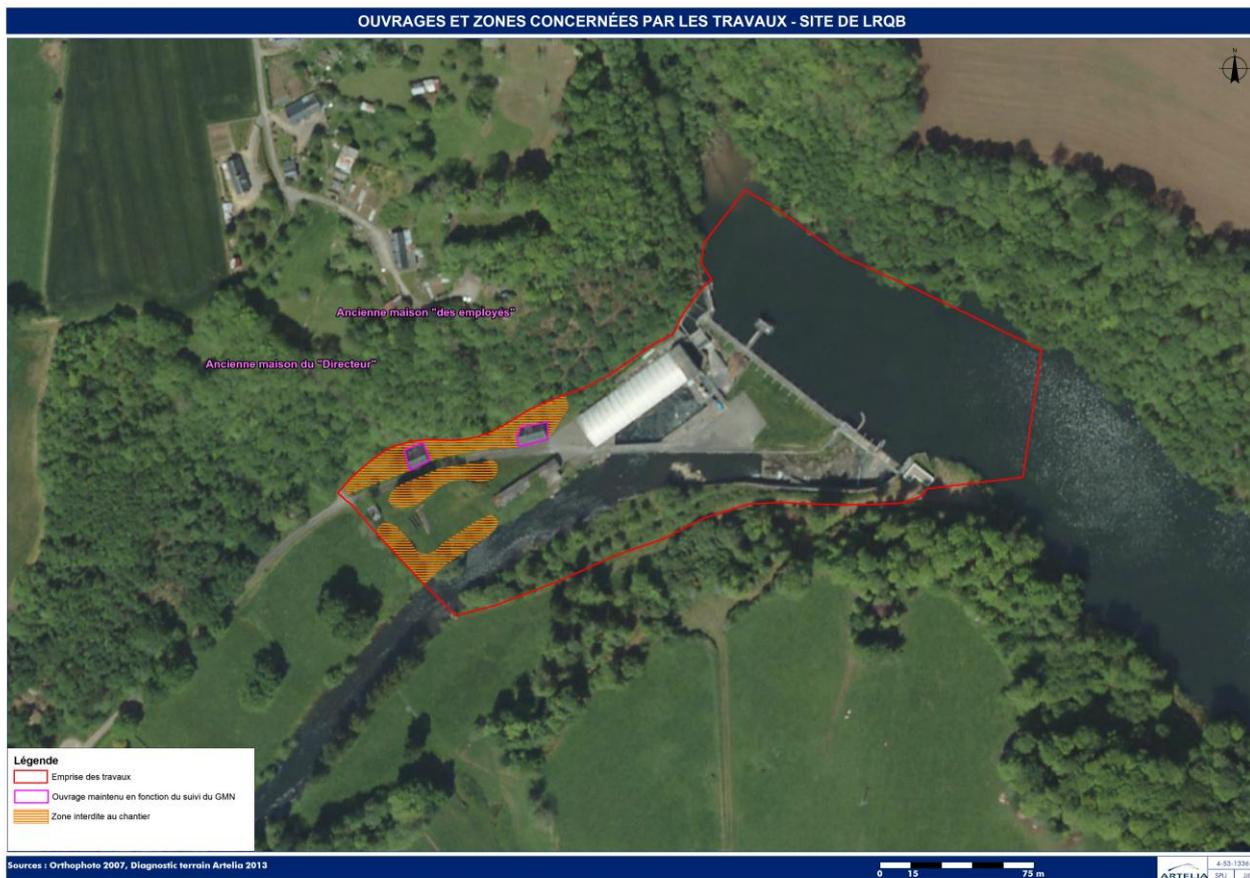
OUVRAGES ET ZONES CONCERNÉES PAR LES TRAVAUX SUR LE SITE DE LRQB
